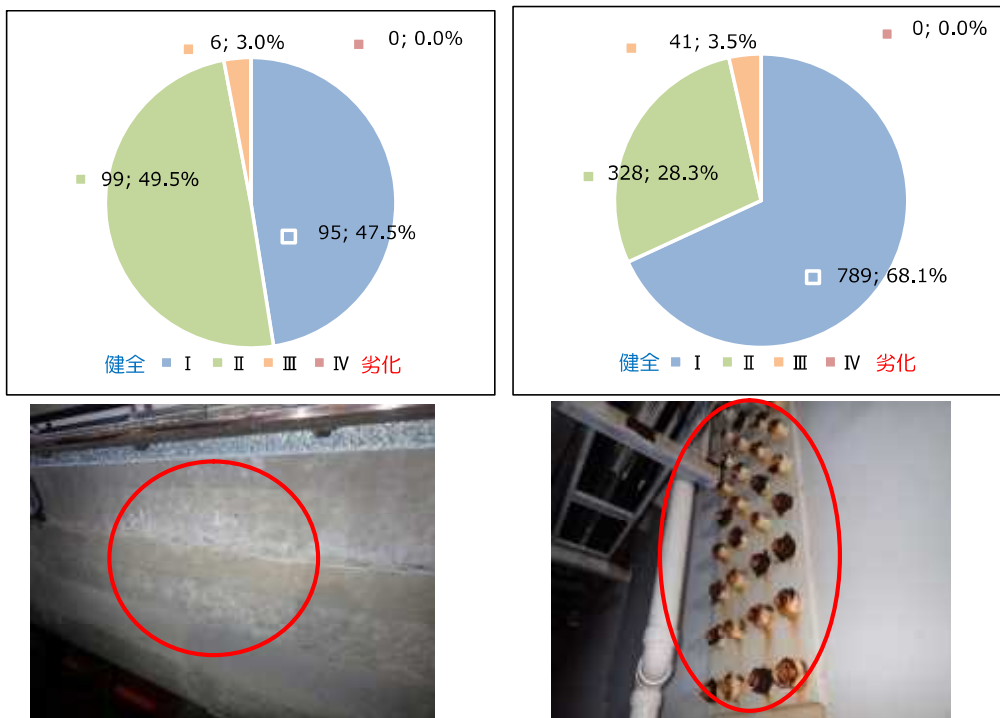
コンクリート部材（左）及び鋼部材（右）の劣化状況
